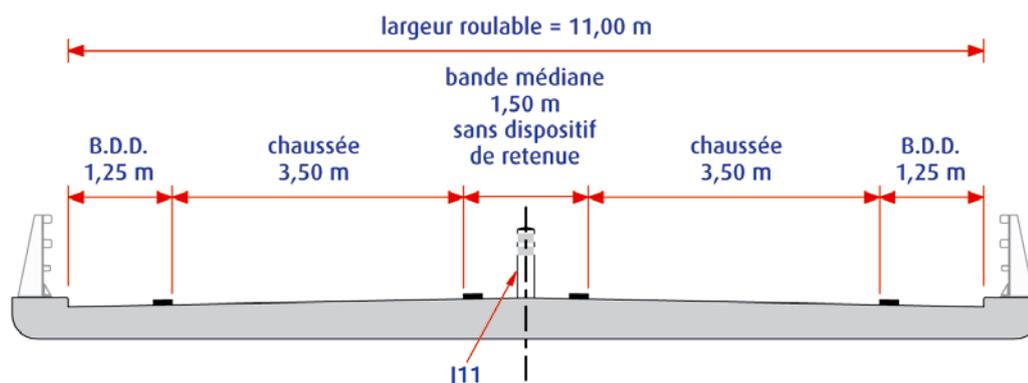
exemple de profil en travers minimal d'un ouvrage d'art non courant
